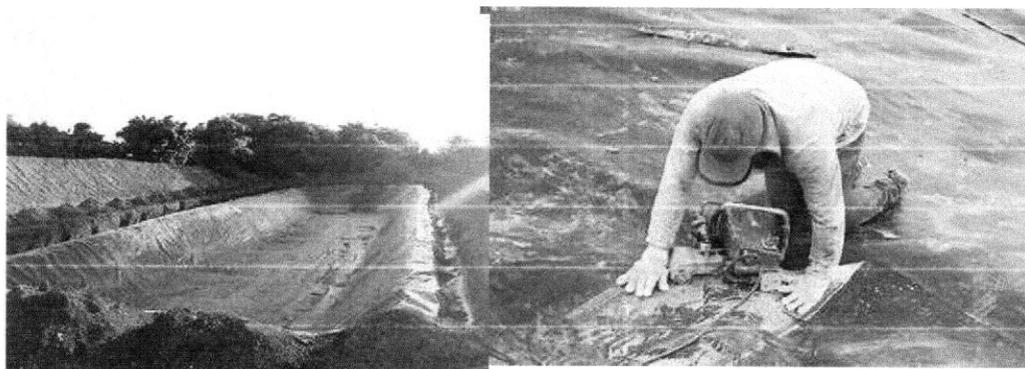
Instalação e emendas em geomembranas PEAD na trincheira.
